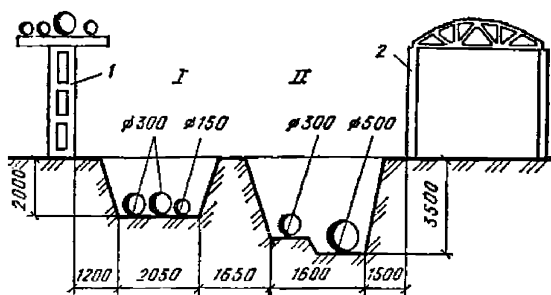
Совмещенная укладка трубопроводов:
